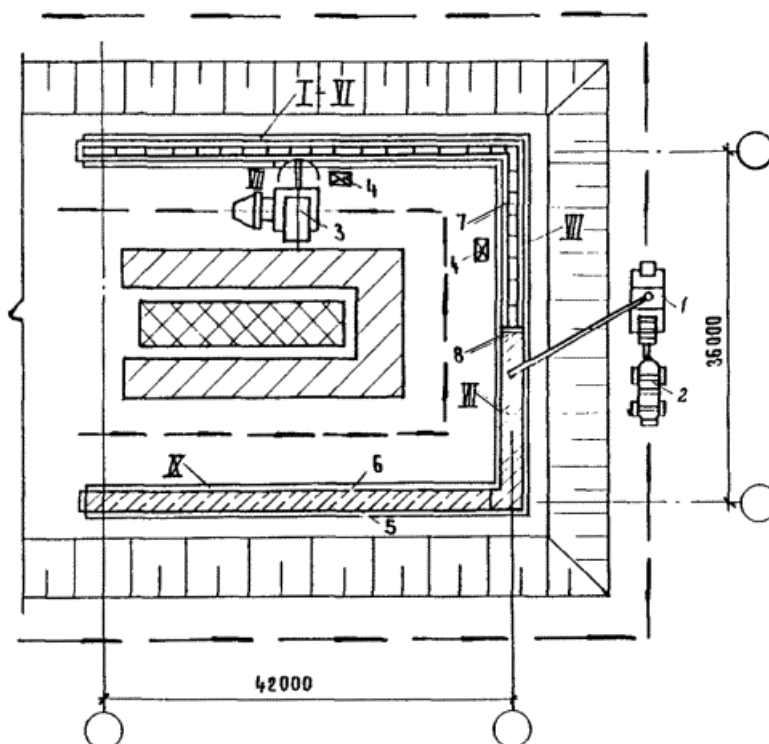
Схемы возведения монолитной железобетонной стены при укладке бетонной смеси с помощью автобетононасоса
